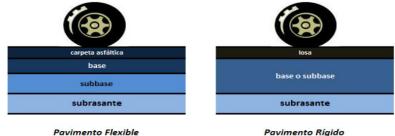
Esquema de paquete estructural para pavimento flexible y rígido Fuente: (Rodríguez, 2009, pág. 5)
